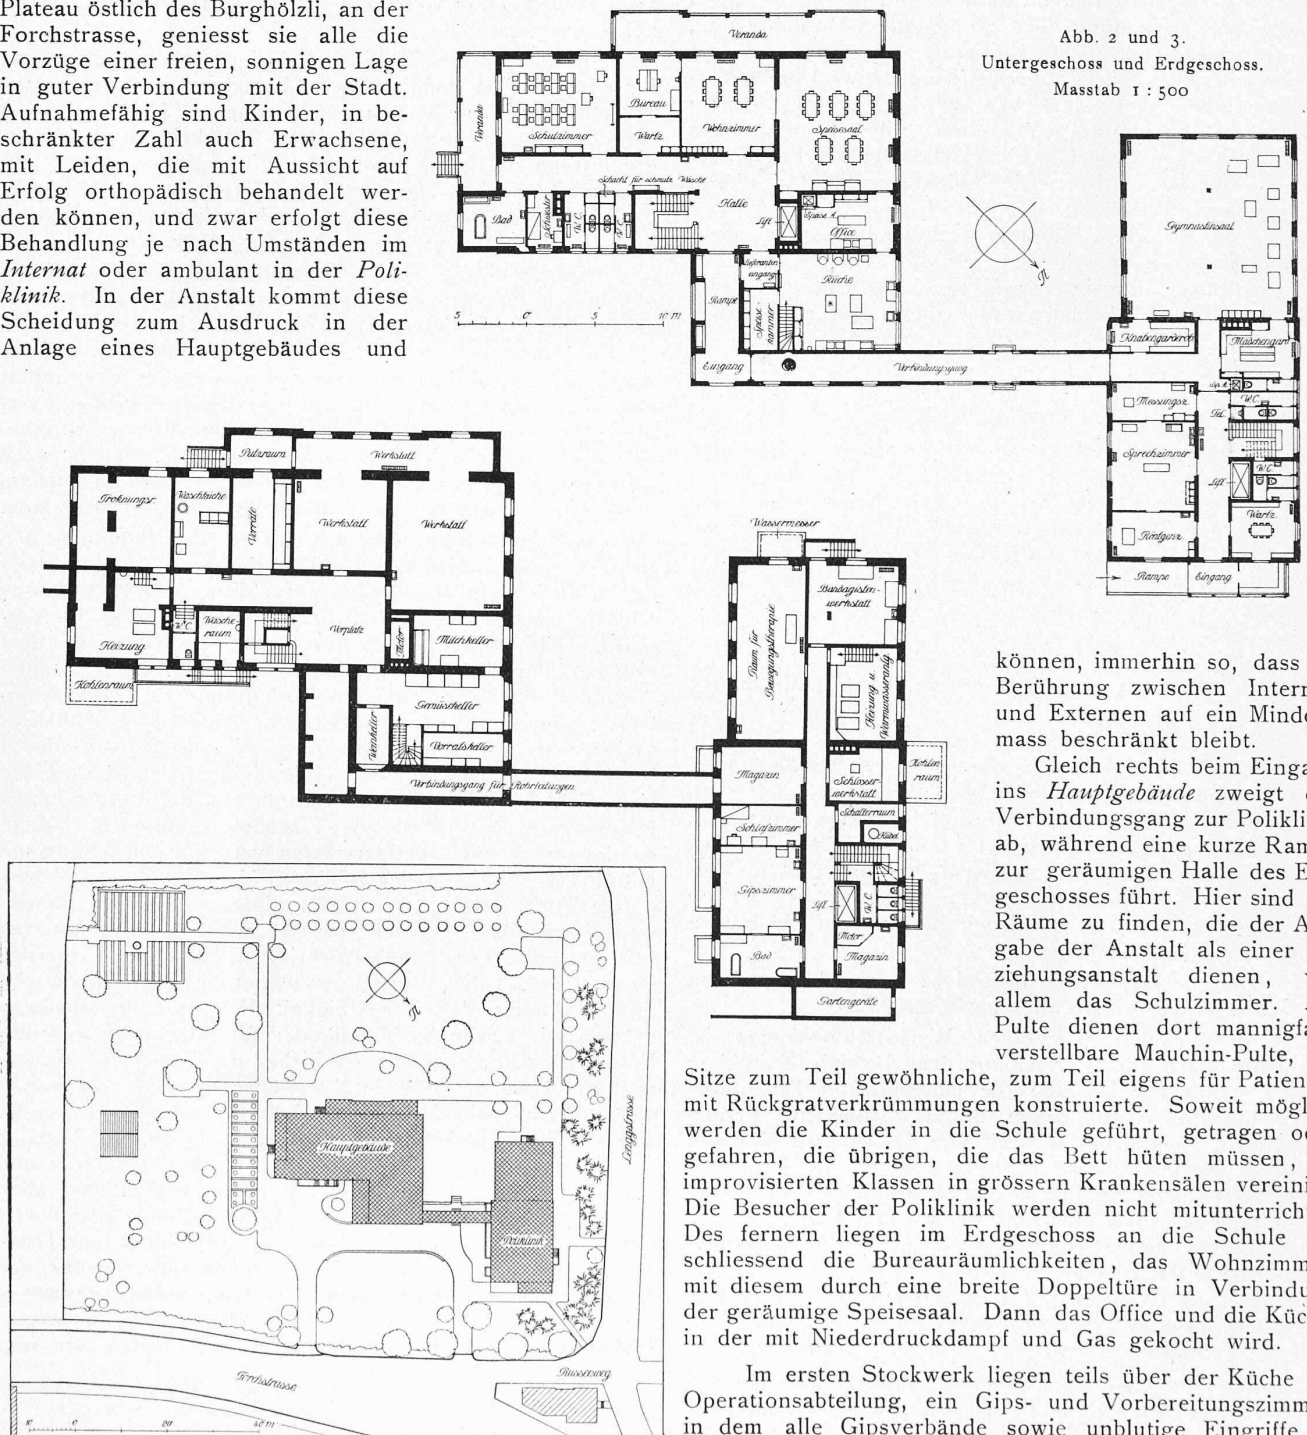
Lageplan der Anstalt Balgrist. — 1:1500.
